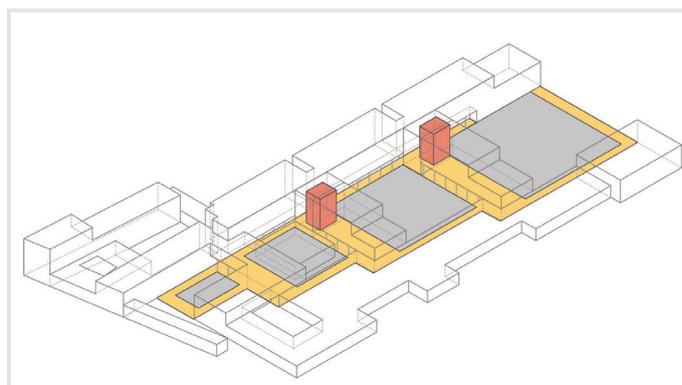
Tutte le funzioni sono disservite dalle piazze centrali
